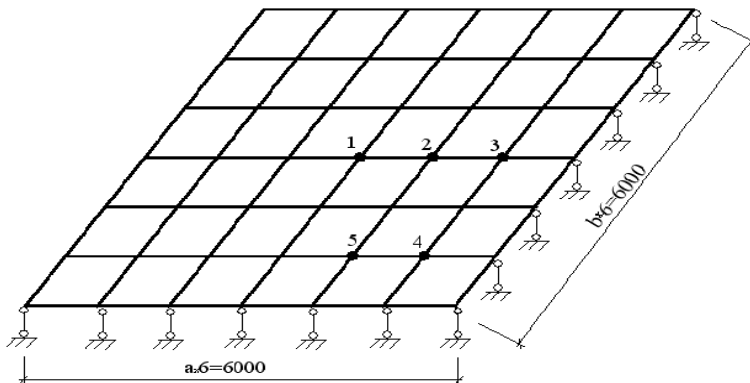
Расчетная схема кессонного перекрытия в виде стержневой аппроксимации
